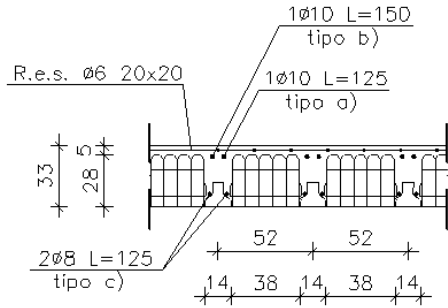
Ex-Lavanderie: pianta solaio di 1° e 2° impalcato
